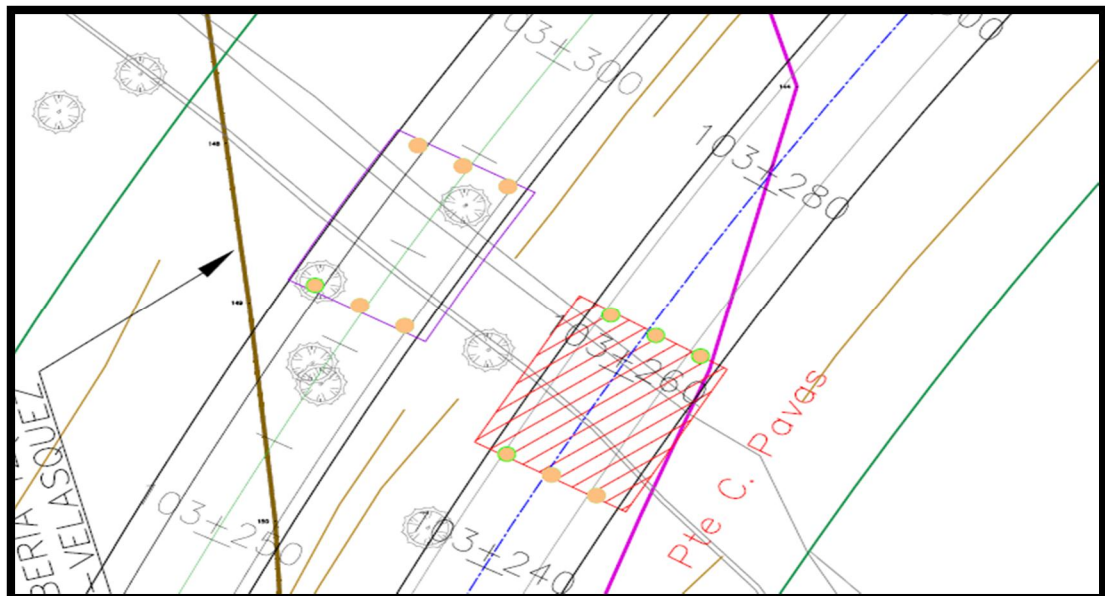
acercamientos críticos con estructuras viales (Puentes) e infraestructura petrolera
